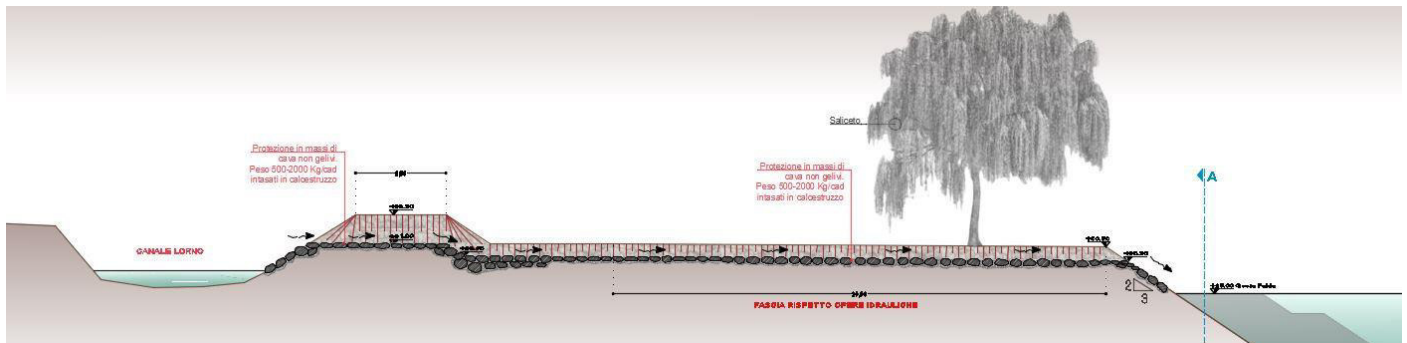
Manufatto di ingresso canale Lorno: sezione.
